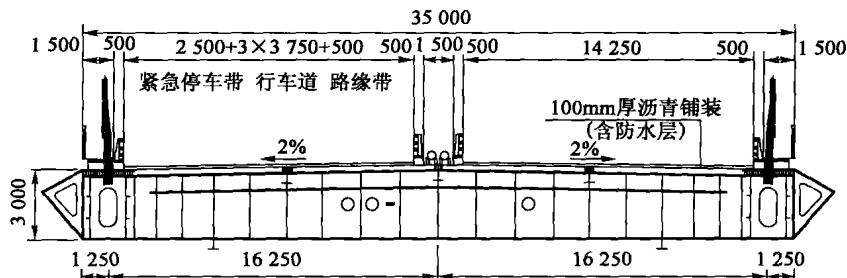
颗珠山大桥主梁横截面(尺寸单位:mm)
